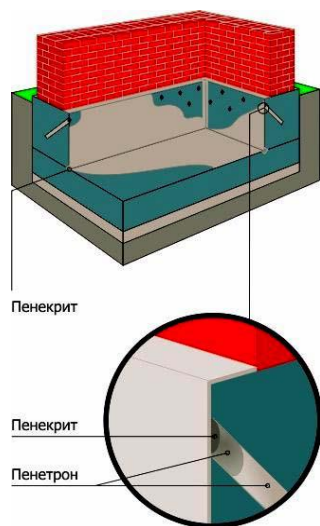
Отсечение капилляр-ного подсоса между бетонным фундаментом и стеной, выпол-ненной из пористого материала
